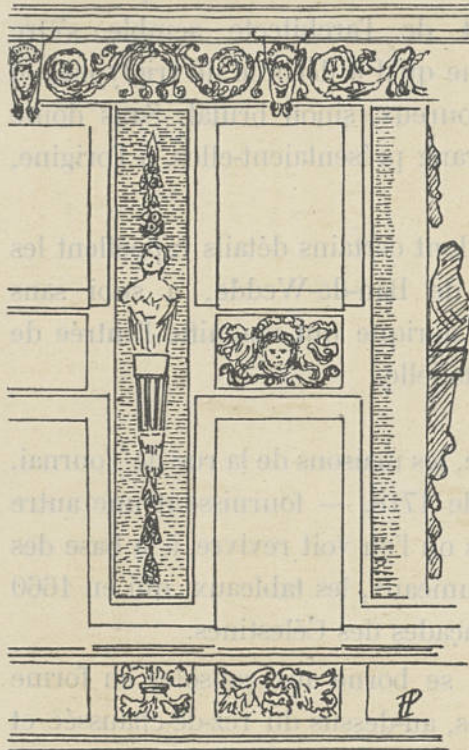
Travée d'une façade d'un type mixte rue Royale, 1-3 (vers 1685).
